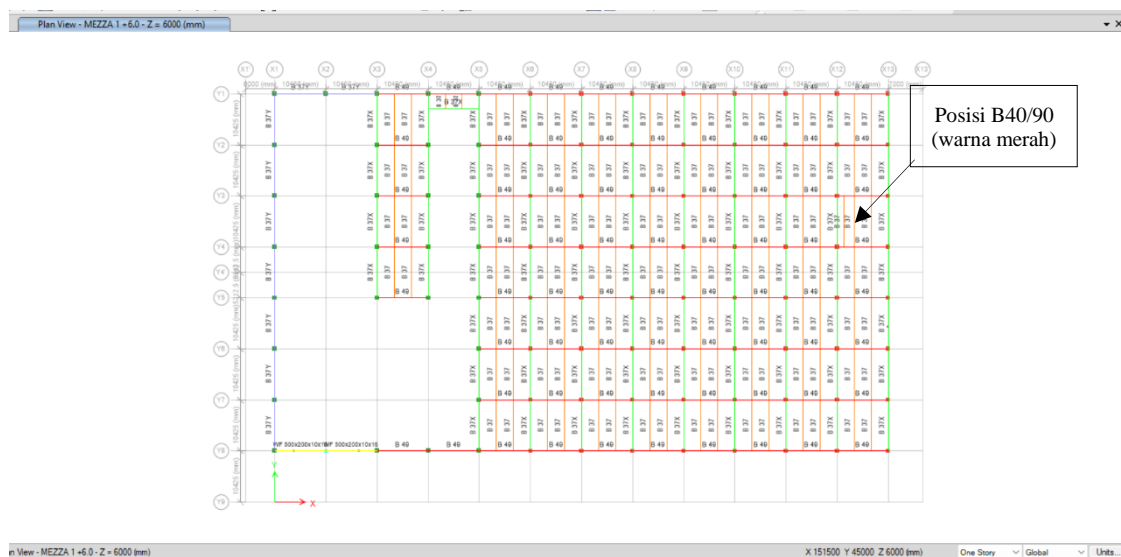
66. Mengganti elevasi Ke Lantai 2
